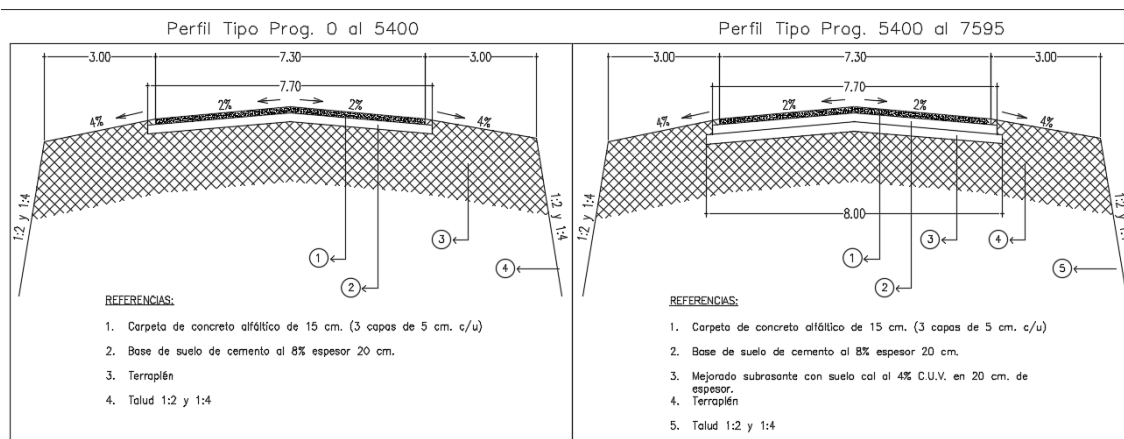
Perfil transversal de estructura. Fuente: DVBA.
